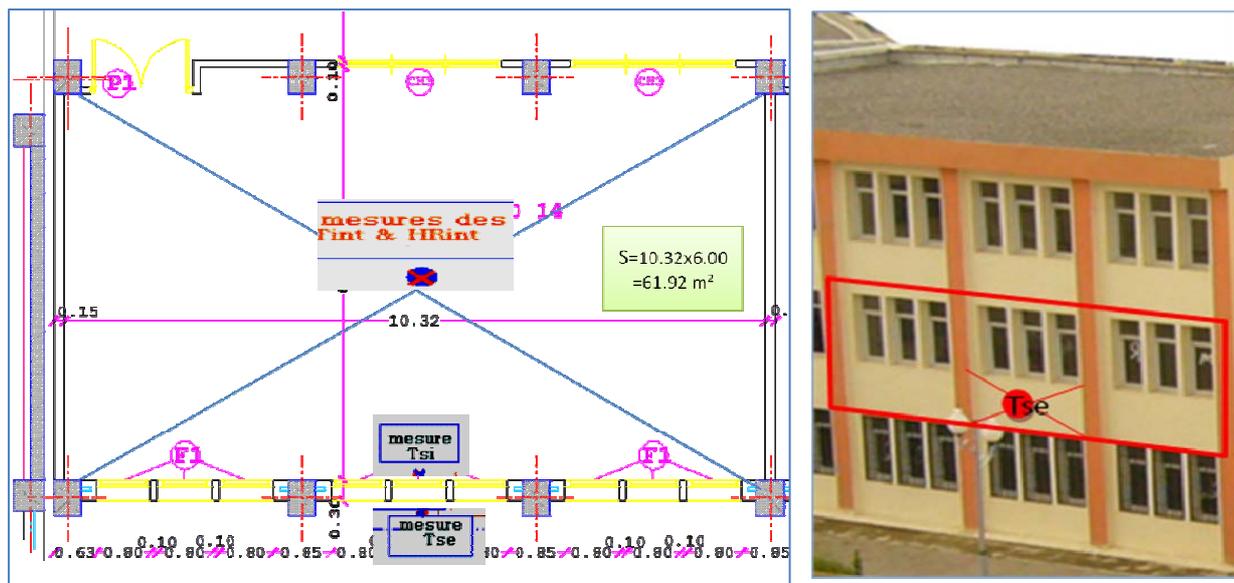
Position des appareils de mesures au niveau du plan et de la façade
